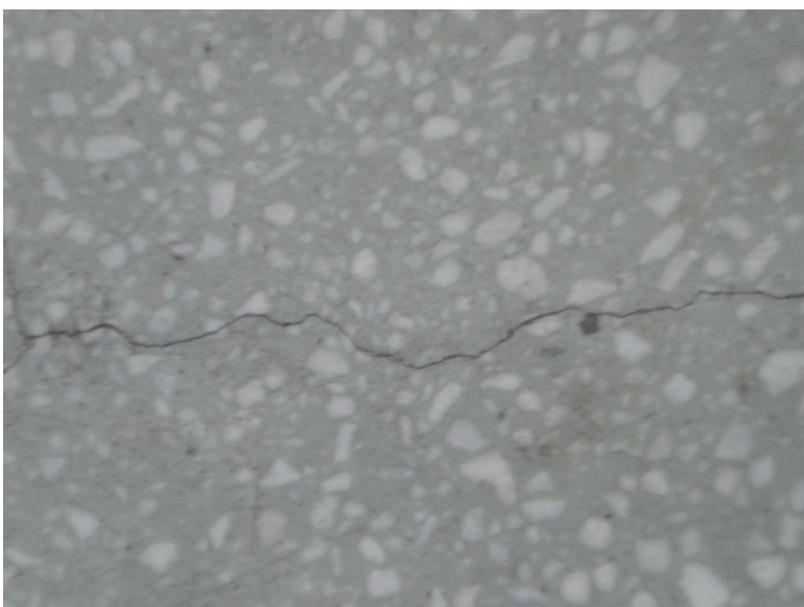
Piso marmorite executado em 2008 – fissuras tipo “mapa”, causadas por retração hidráulica, e desgaste superficial. Foto da autora.
